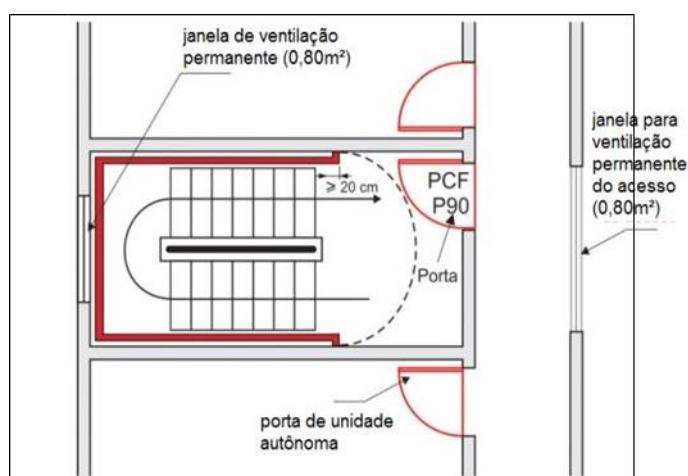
Ventilação da escada enclausurada protegida e seu acesso.
